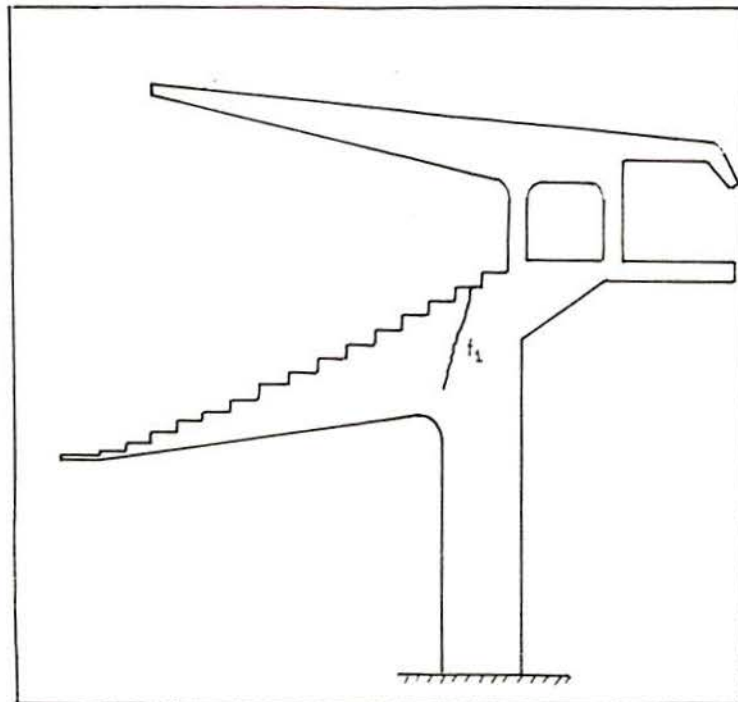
Esquema de fissuras no pórtico 3 para 12 KN.
